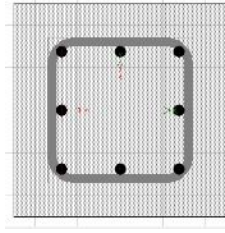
Sección transversal de la columna analizada. Fuente: Elaboración propia.
